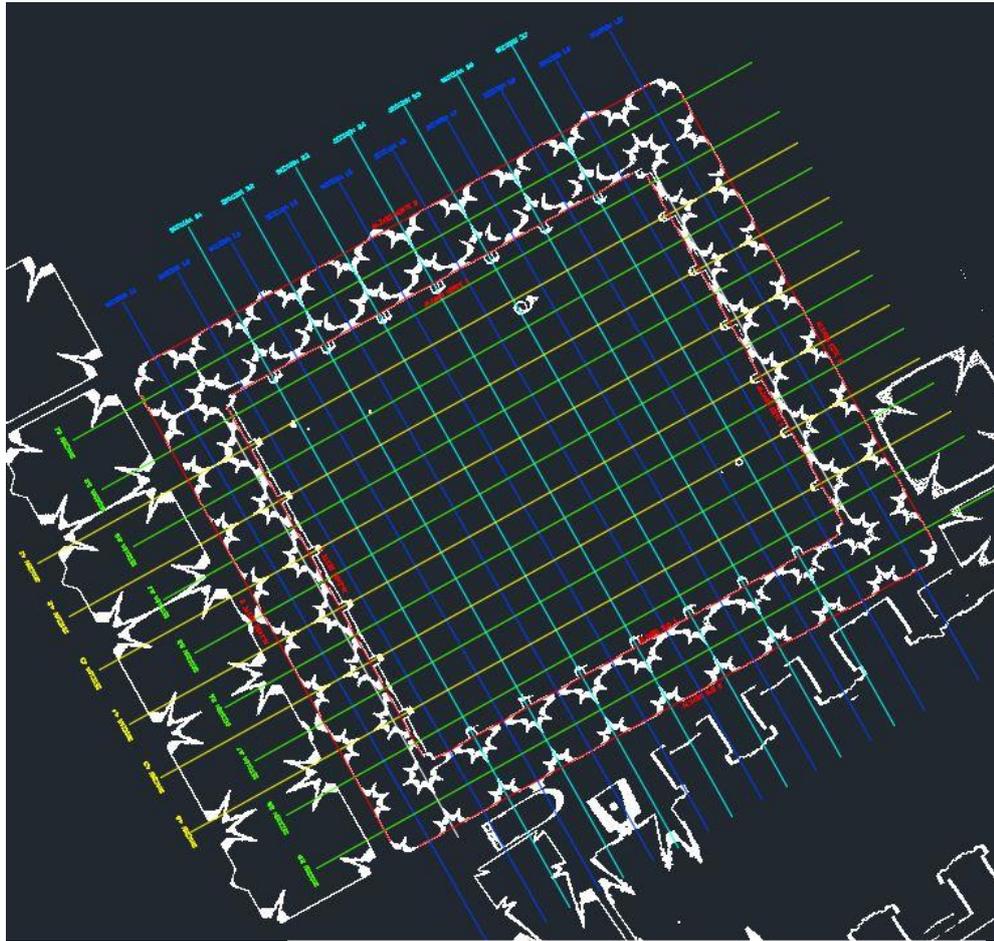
Sección horizontal en AutoCad donde se marcan las secciones verticales.
